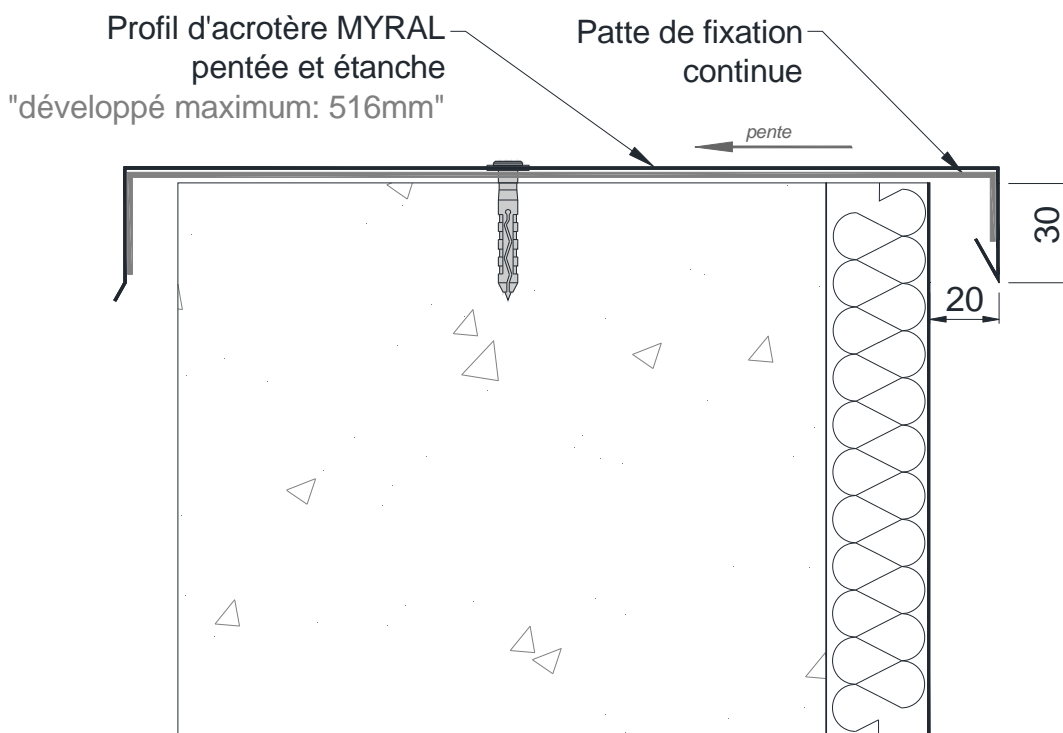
Haut de façade – Pose en bardage simple réseau (coupe verticale)
